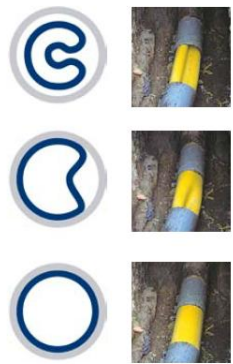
Corte longitudinal de tubería renovada. (WAVIN, 2012)
